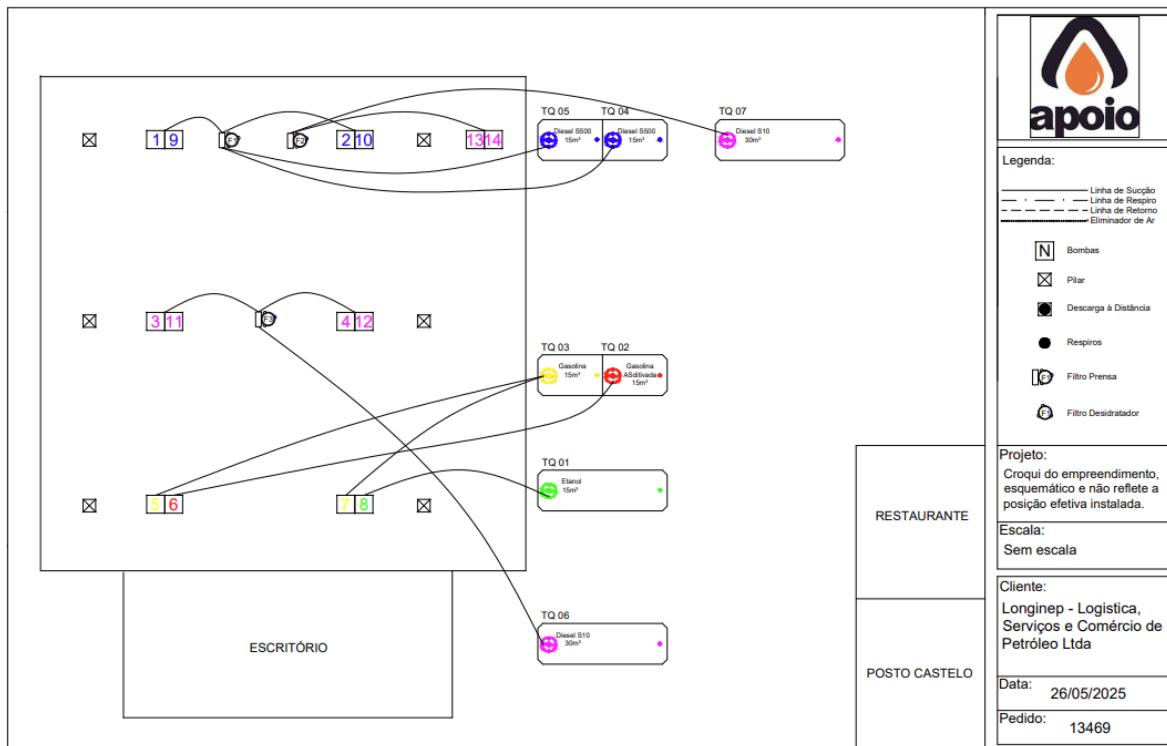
Croqui do empreendimento esquemático. Fonte: SLA
